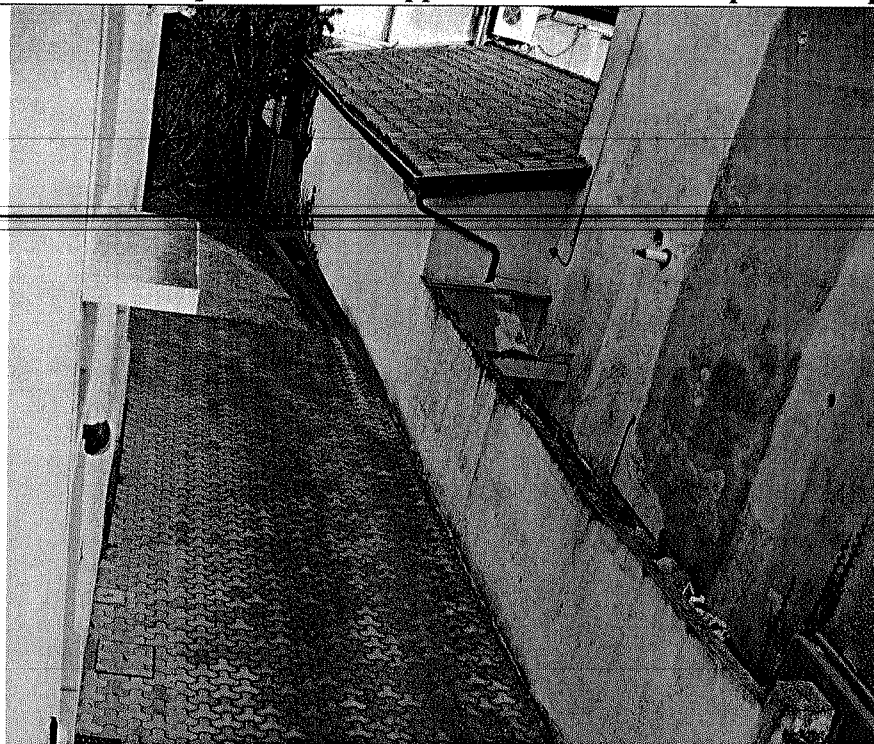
VISTA DEL LATO SUD DEL LOTTO
